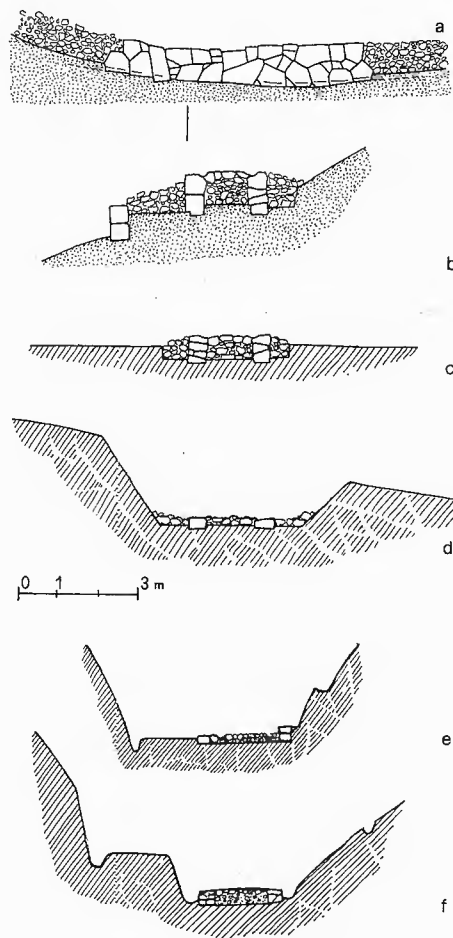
Strade arcaiche al Laurentino: prospetto di una costruzione (a) e sezioni (b-f).
